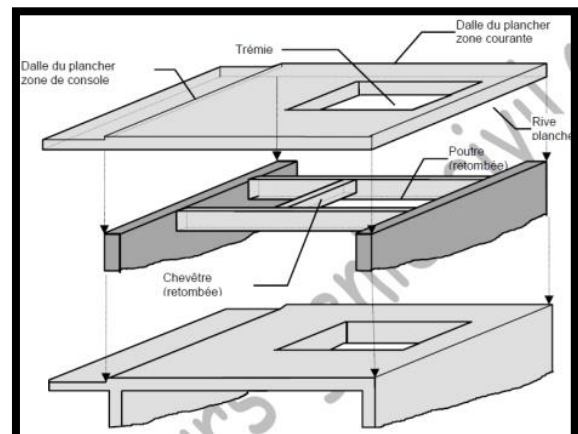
un réseau porteur horizontal constitué de poutre, poutrelles et chevêtres .Source : Cours : Bâtiment 2
